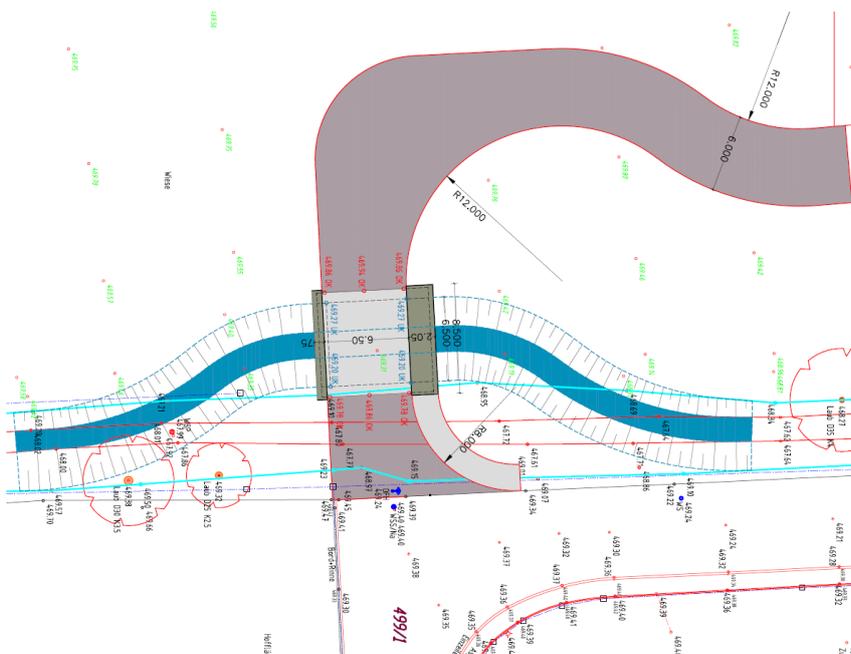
Planung Brücke, Gewässerumverlegung, Erschließungsstraße (ROPLAN, 16.11.2022)
